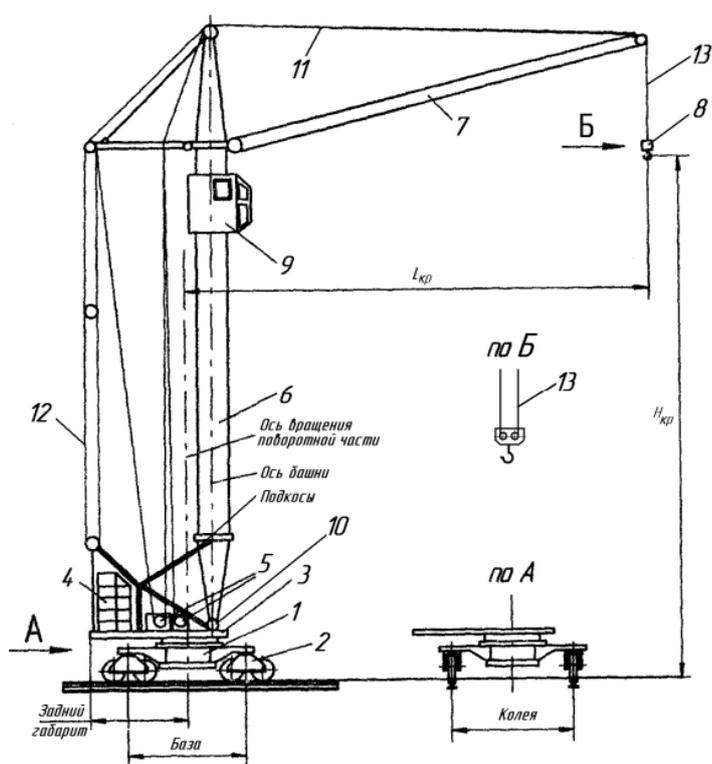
Кран башенный с поворотной башней КБ-302А: $L_{кр}$ – вылет крюка крана; $H_{кр}$ – высота подъёма крюка; $L_{кр}$ – вылет крюка кран
